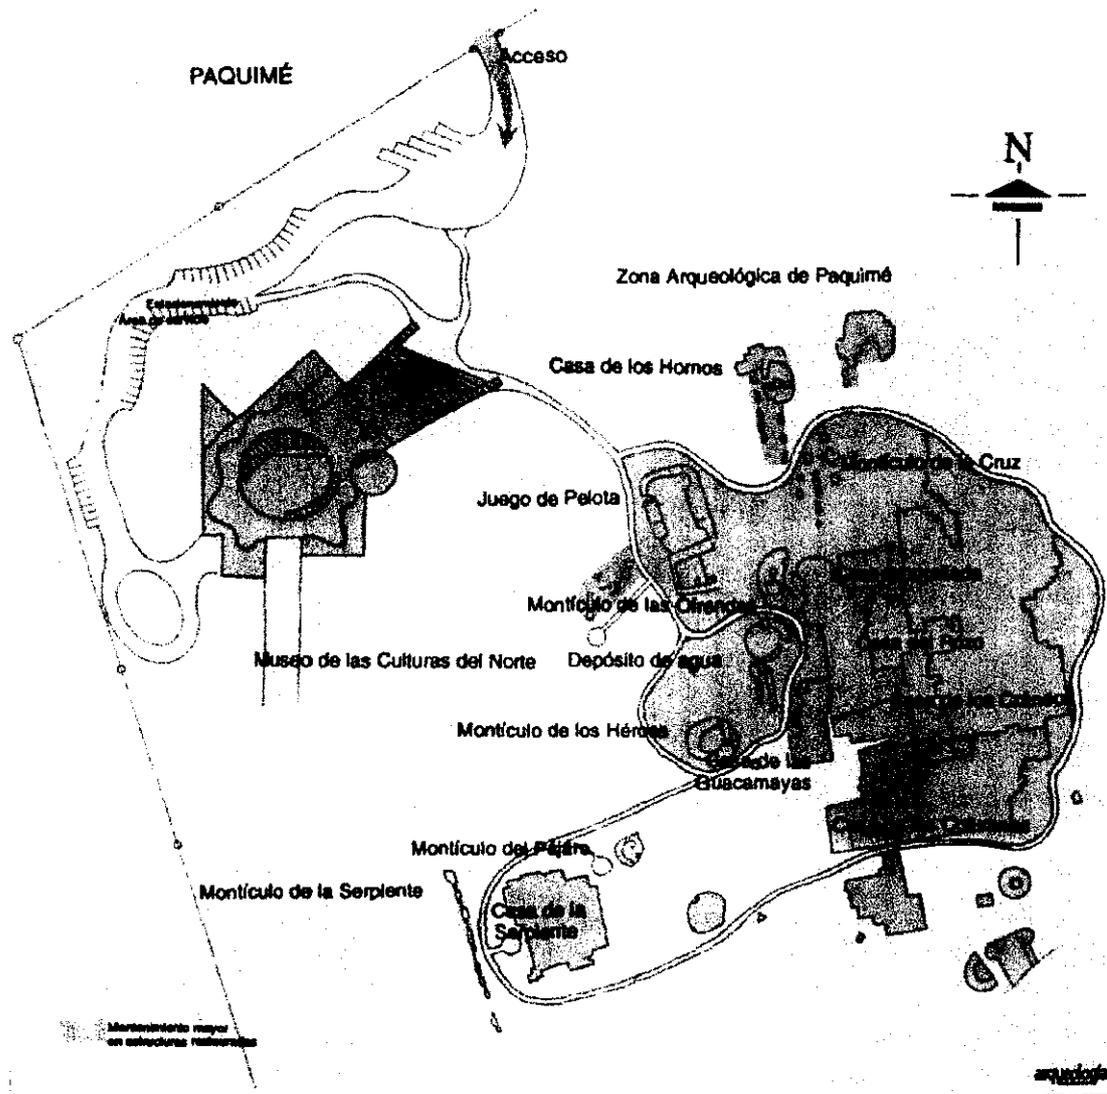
Planta de conjunto de la zona arqueológica y museo de sitio.
